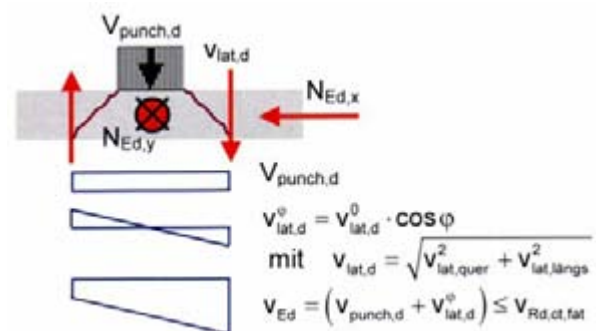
Modellgrundlage für den Ermüdungsnachweis von Beton unter Durchstanzbeanspruchung
